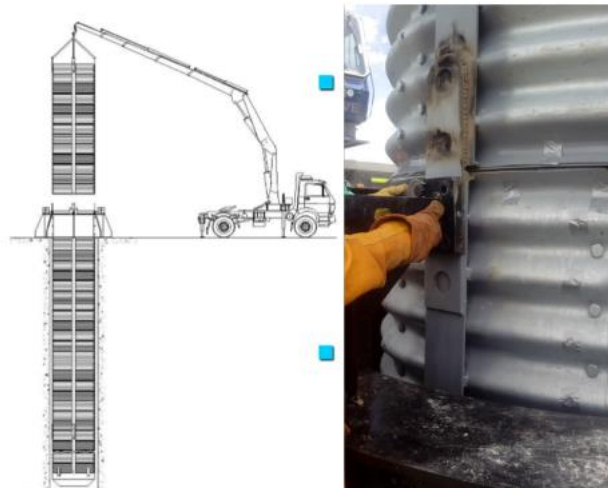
Anclado y soldado de anillos para la chimenea
